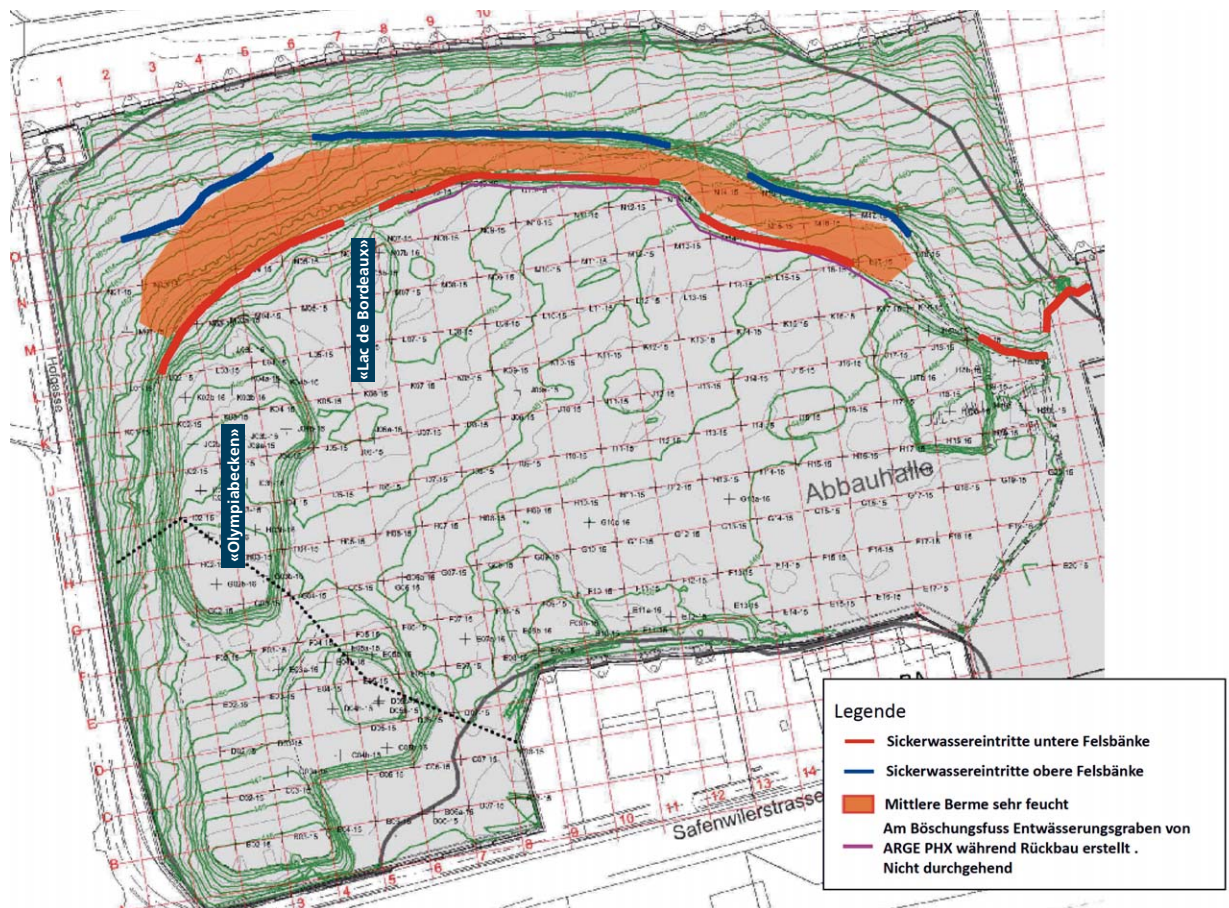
Situation in der Abbauhalle mit Wasseraustritten und bestehenden Entwässerungsmaßnahmen
